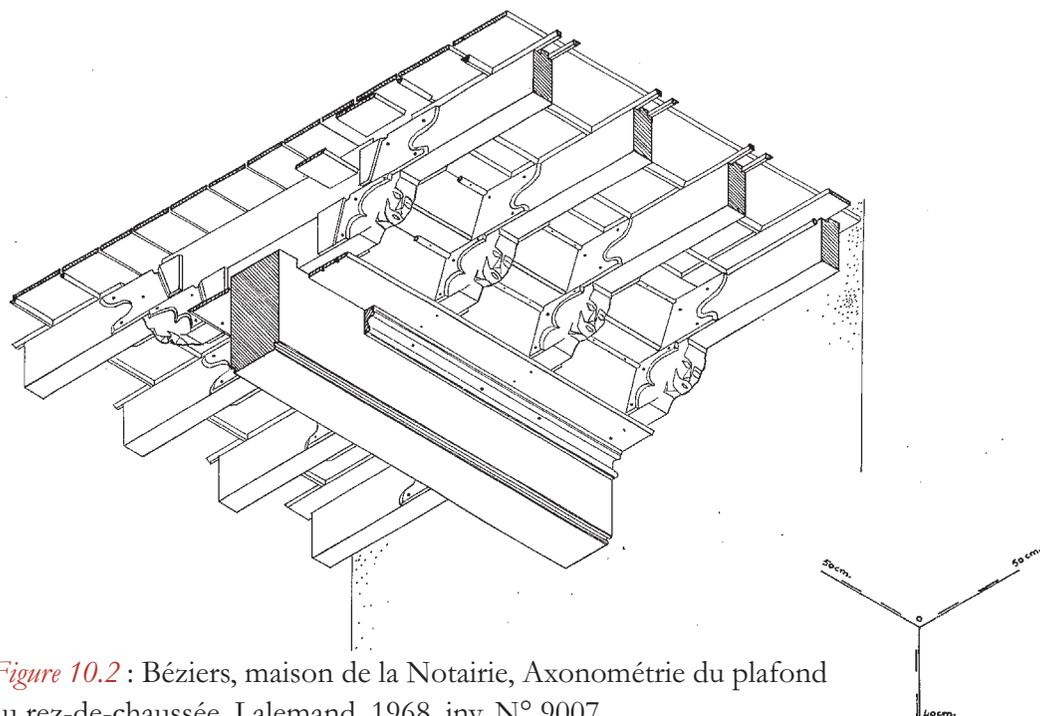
Béziers, maison de la Notairie, Axonométrie du plafond su rez-de-chaussée, Lalemand, 1968, inv. N° 9007.
